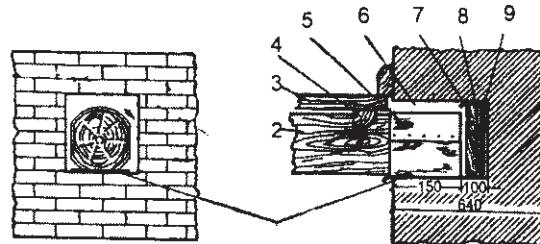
Заделка концов деревянных балок междуэтажных перекрытий в стену толщиной 2½ кирпича
